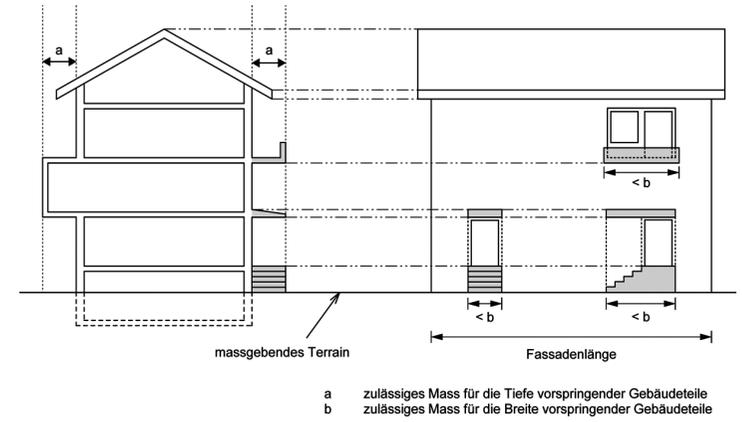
a Fassadenflucht und Fassadenlinie (in ebenem Gelände)
